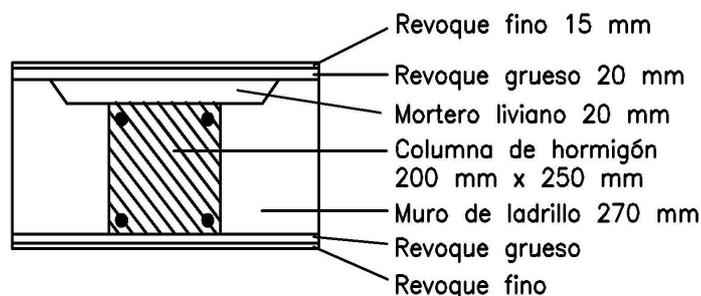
Columna de hormigón en un muro de ladrillo macizo.
